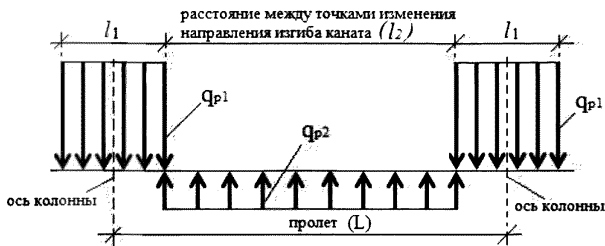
Дополнительные нагрузки в конструкциях от поперечных вертикальных составляющих усилий натяжения
